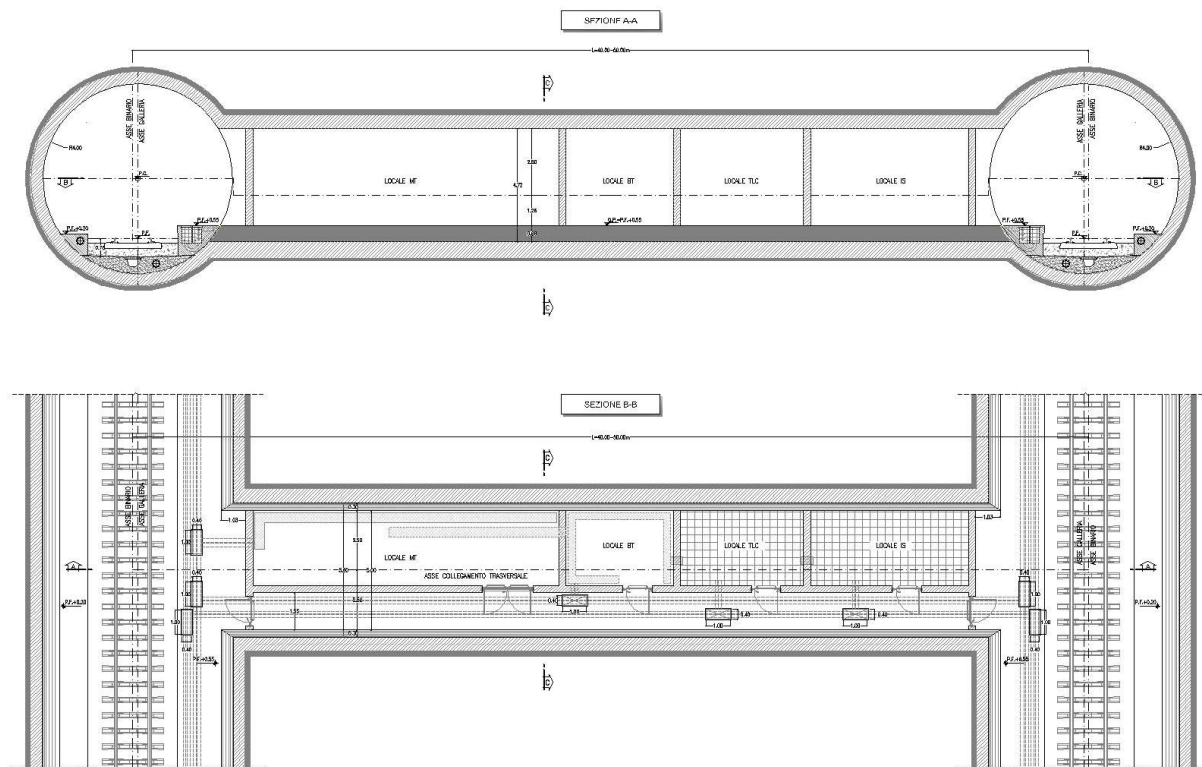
Planimetria e profilo longitudinale by-pass tecnologico
